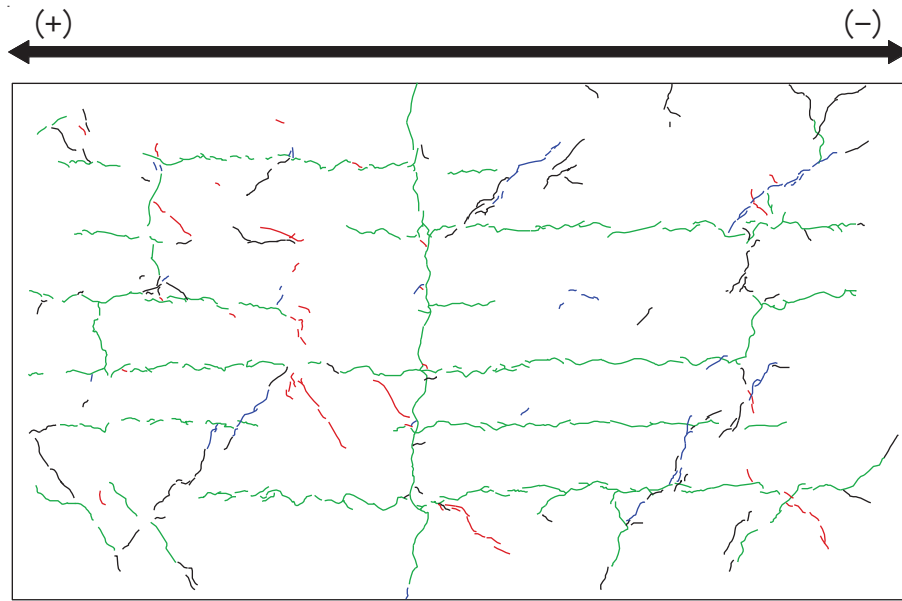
(5) 乾燥試験体 [1] 1/2500rad. におけるひび割れ図
